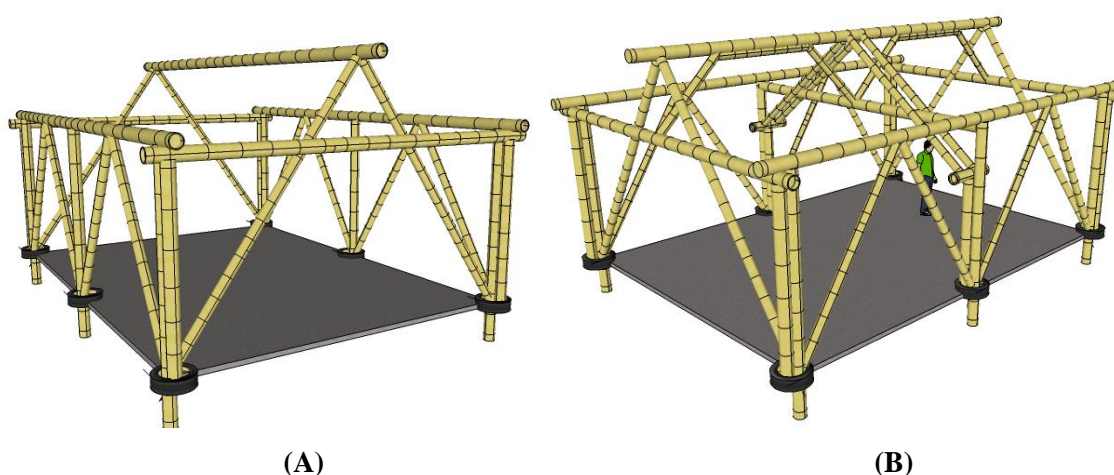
Figura 83a: Coluna inclinada e travamentos centrais. Figura 83b: Suporte para viga principal. Modelo: Autor (2011).
